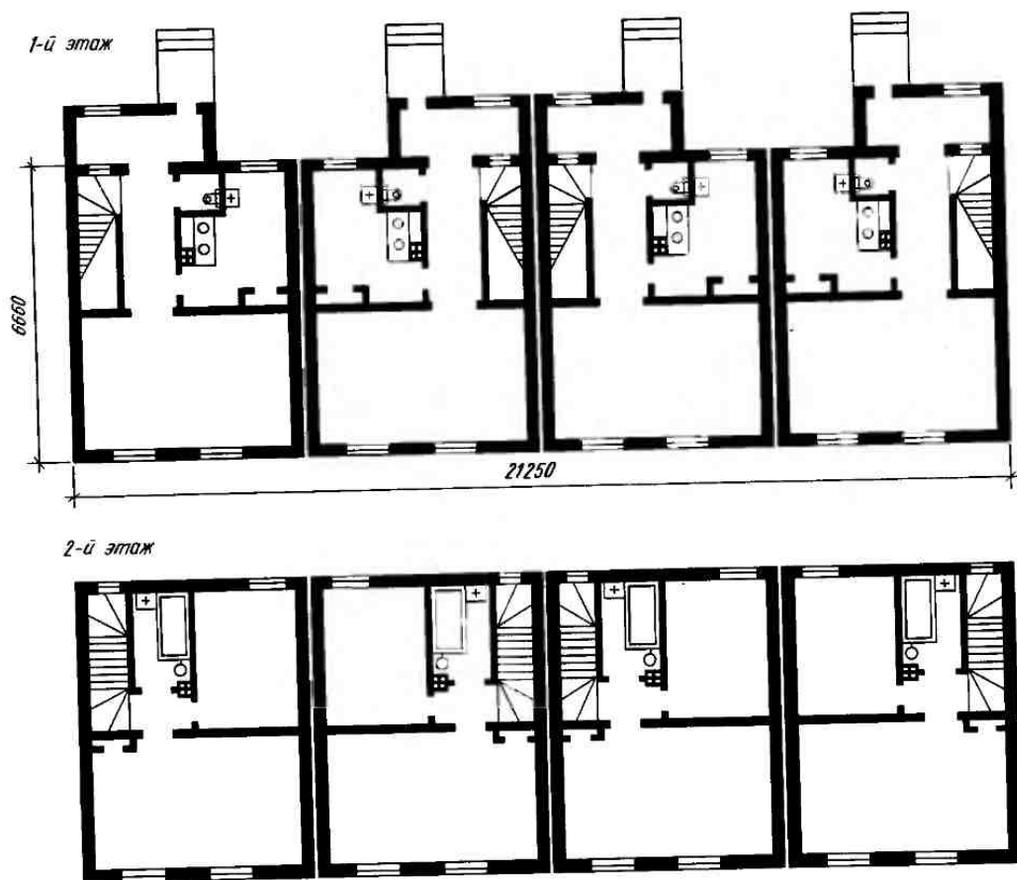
План жилого дома из объемных блоков размером на квартиру
